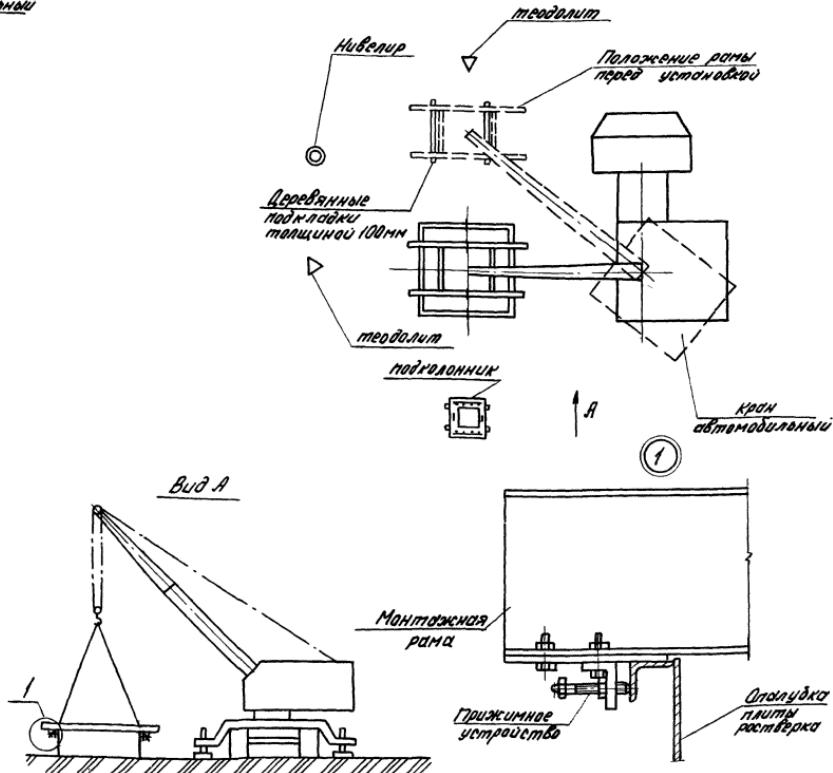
Схема установки монтажной рамы на опоры плиты растворка
